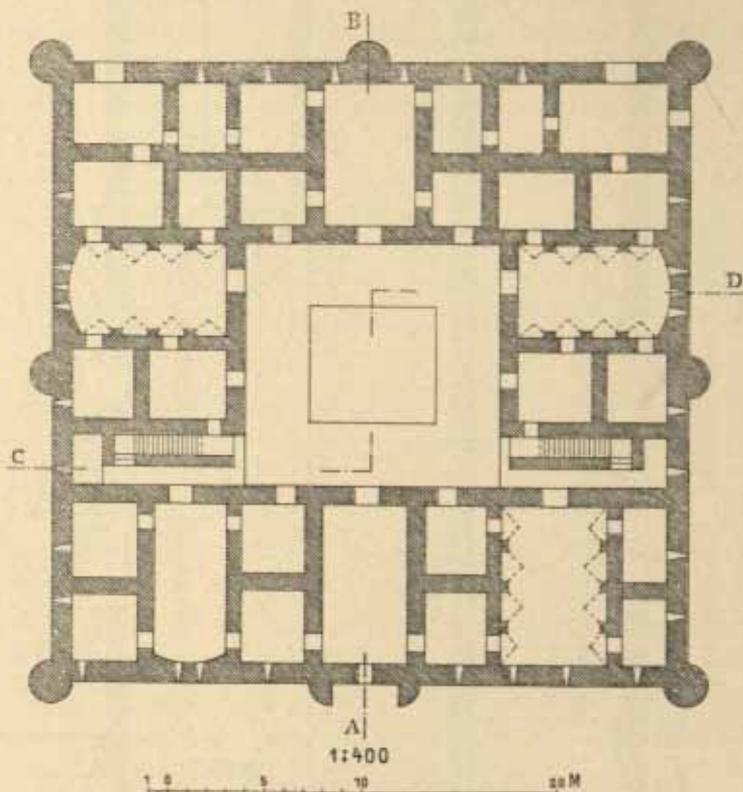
Kaṣr al-Ĥarāni. Grundriß des Obergeschosses.
